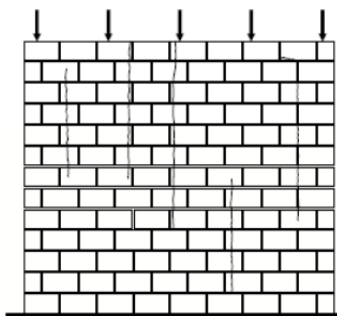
Configuração das fissuras originadas pelo carregamento. [8]
